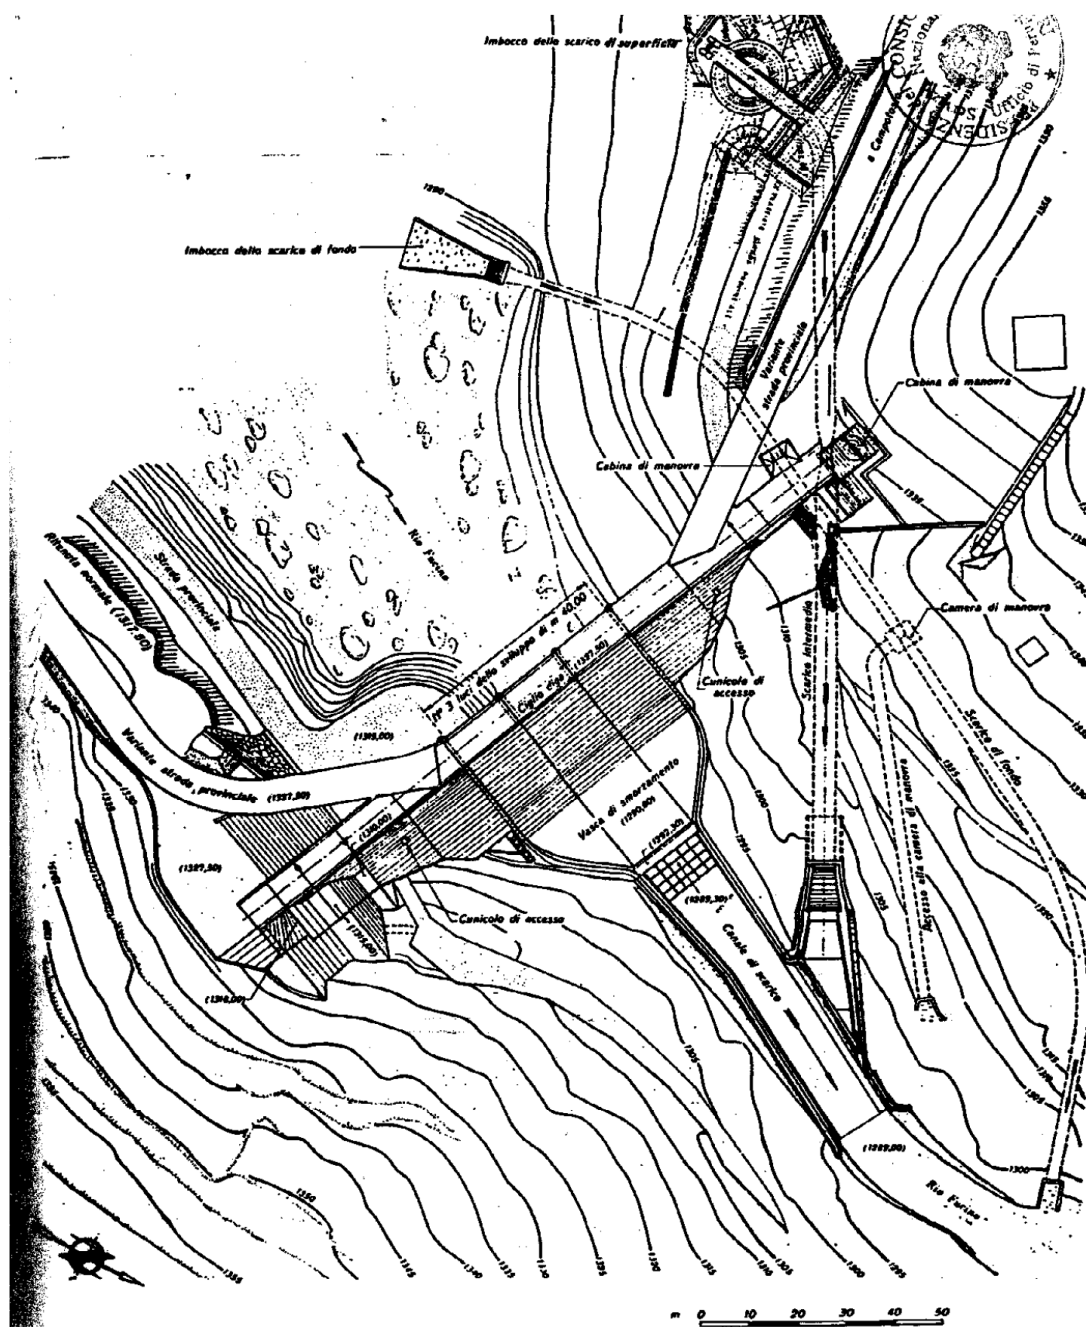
Diga di Rio Fucino - planimetria generale (fonte: FCEM).
